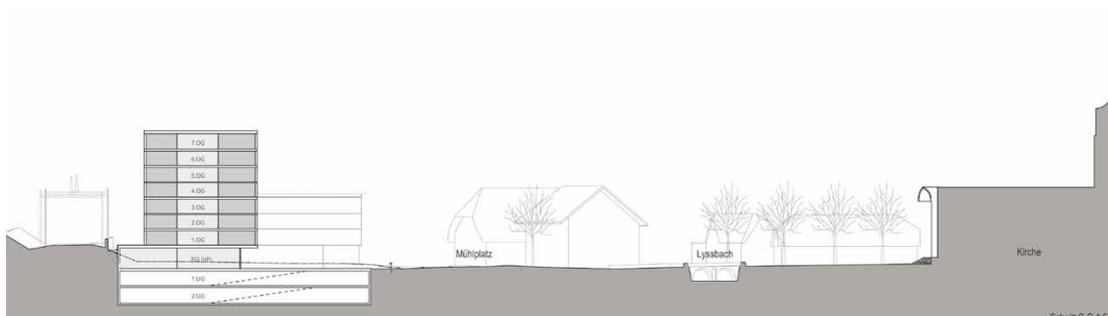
Schnitt Bahndamm - Planungsgebiet - Mühle-Ensemble - Lyssbach - Kirche
